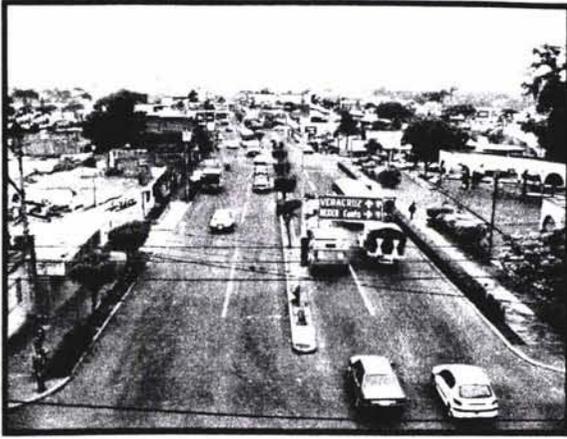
Avenida 11. Acceso a la Autopista Vista Sur
